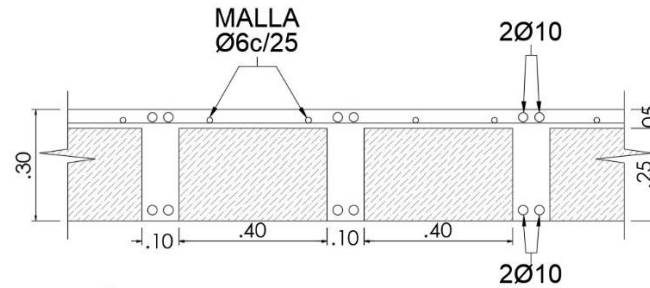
SECCION TIPO LOSA RETICULAR $e = 30 \text{ CM}$
